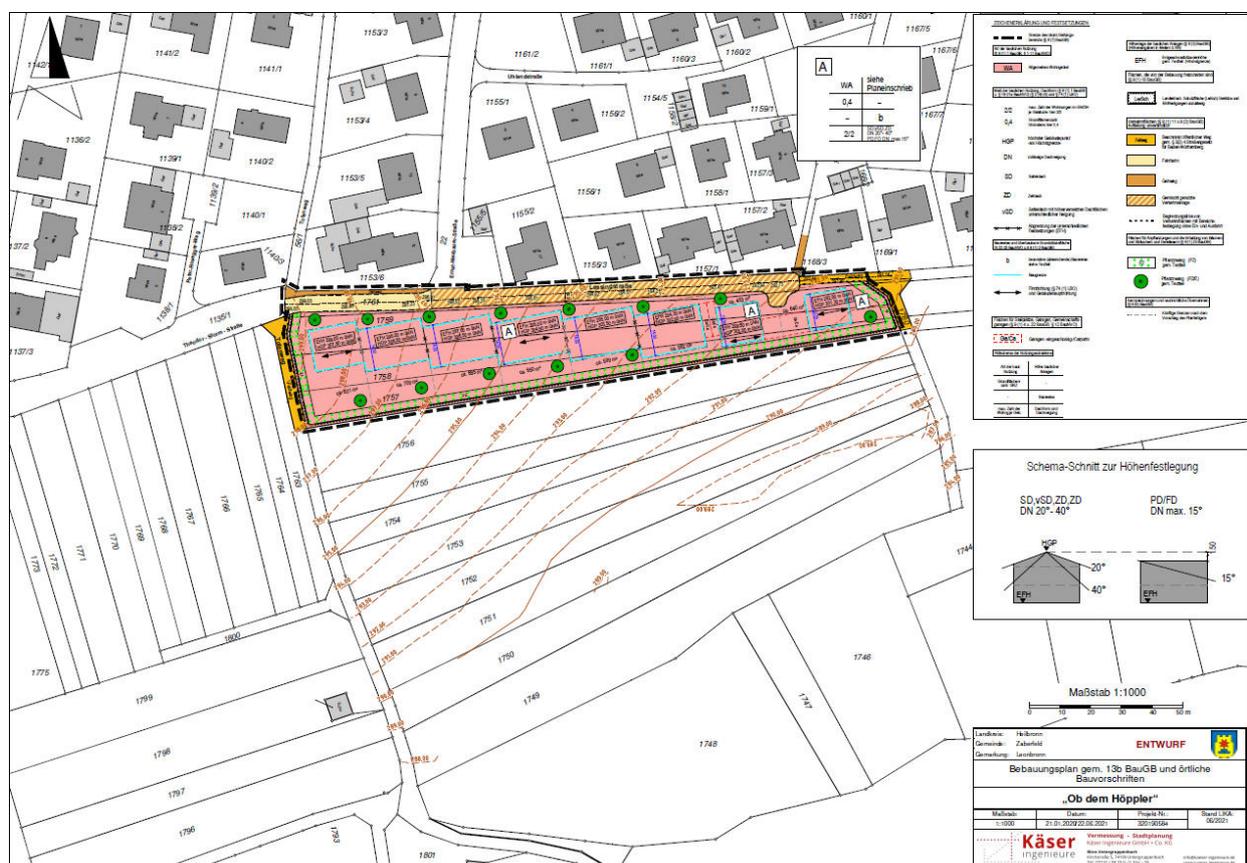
Bebauungsplan "Ob dem Höppler" Entwurf (KÄSER INGENIEURE, Stand 21.01.2020/22.06.2021)
